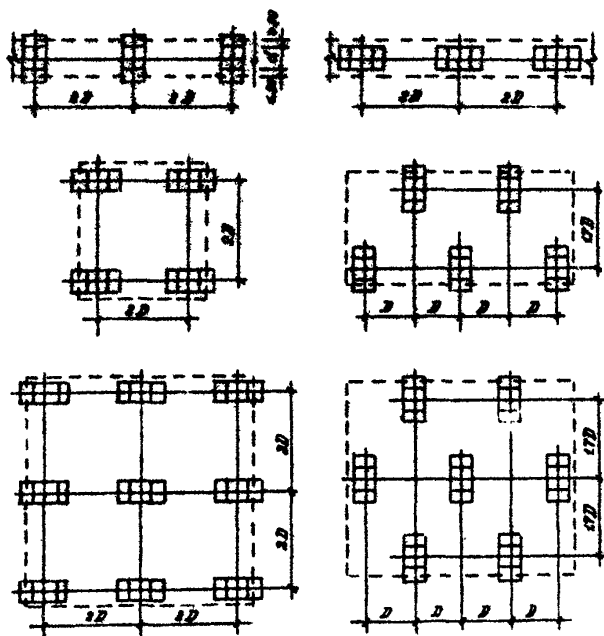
Типовые схемы размещения плоскопрофилированных свай в фундаментах
